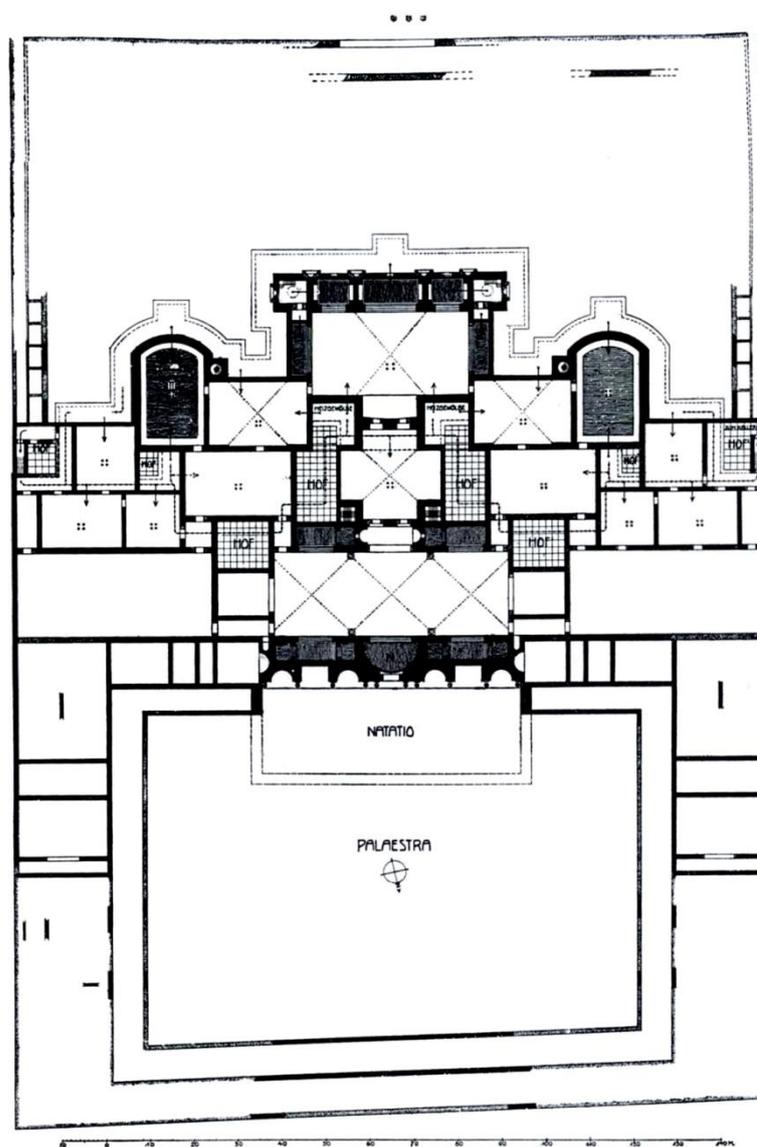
Terme di S. Barbara, Treviri. Pianta
